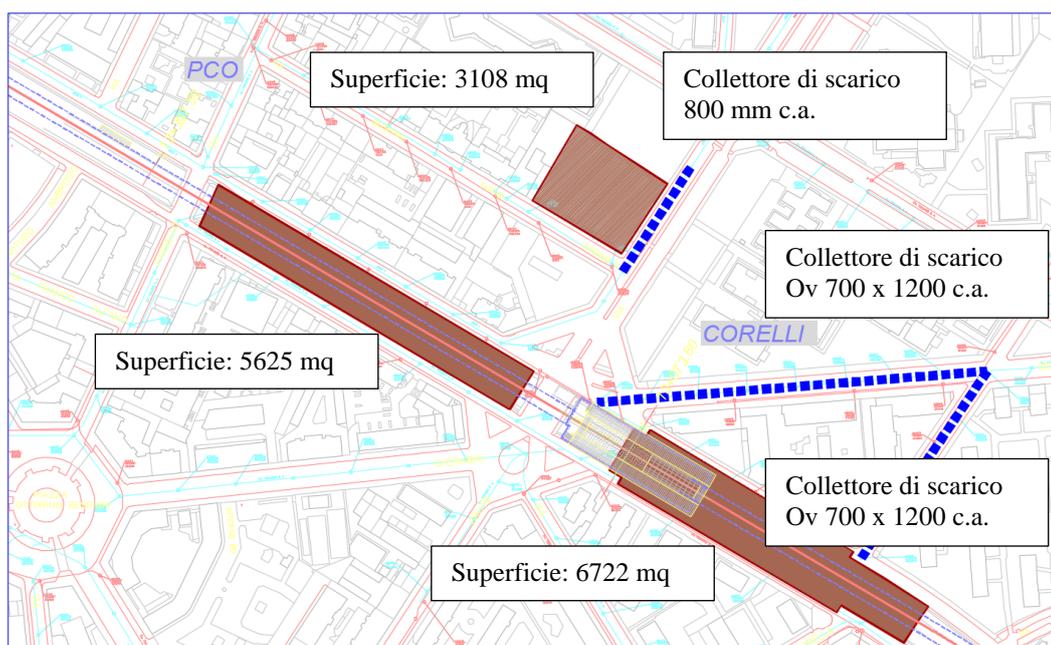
Aree di cantiere – Stazione Corelli – FASE 1
